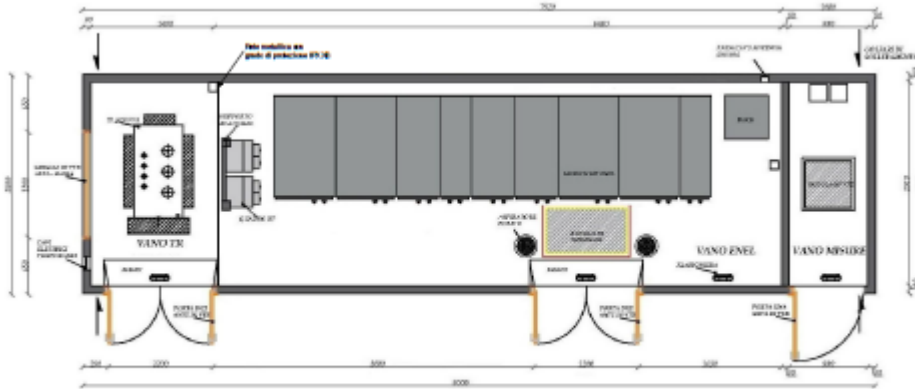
Vista in pianta della cabina di consegna DG 2092 rev3.
